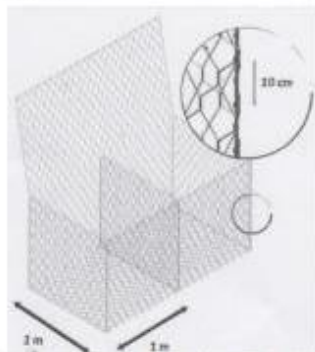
Amarrado de las aristas del gavión. Fuente: (ACEROS METALES Y MALLAS LTDA, 2016)
